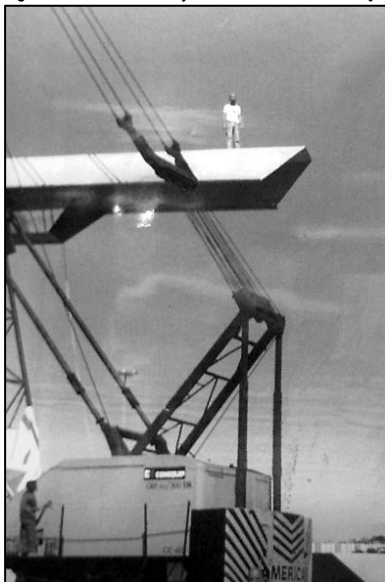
TRRM. Projeto: Brena e Carlevaro [1976] Construção (içamento) da cobertura [198-][Fonte: Acervo TRRM]
